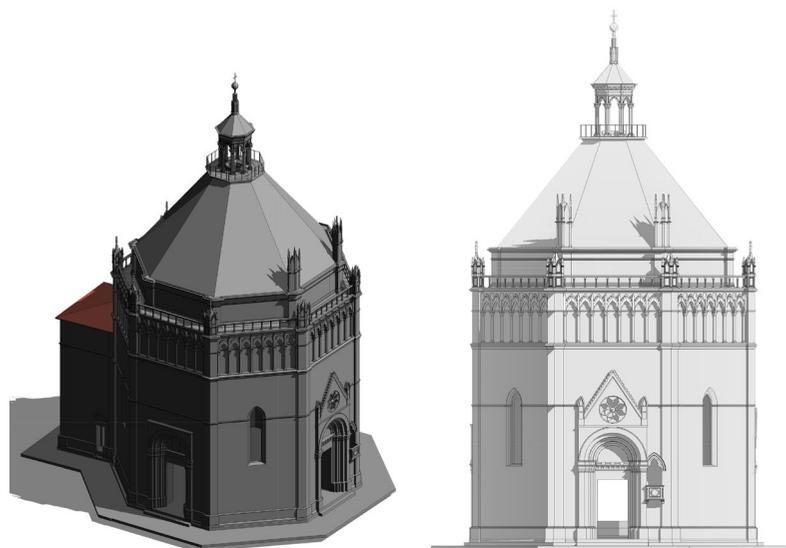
Elaborati modellazione in Revit: assonometria e prospetto ingresso (elab. V. D'Andraia, 2023).
